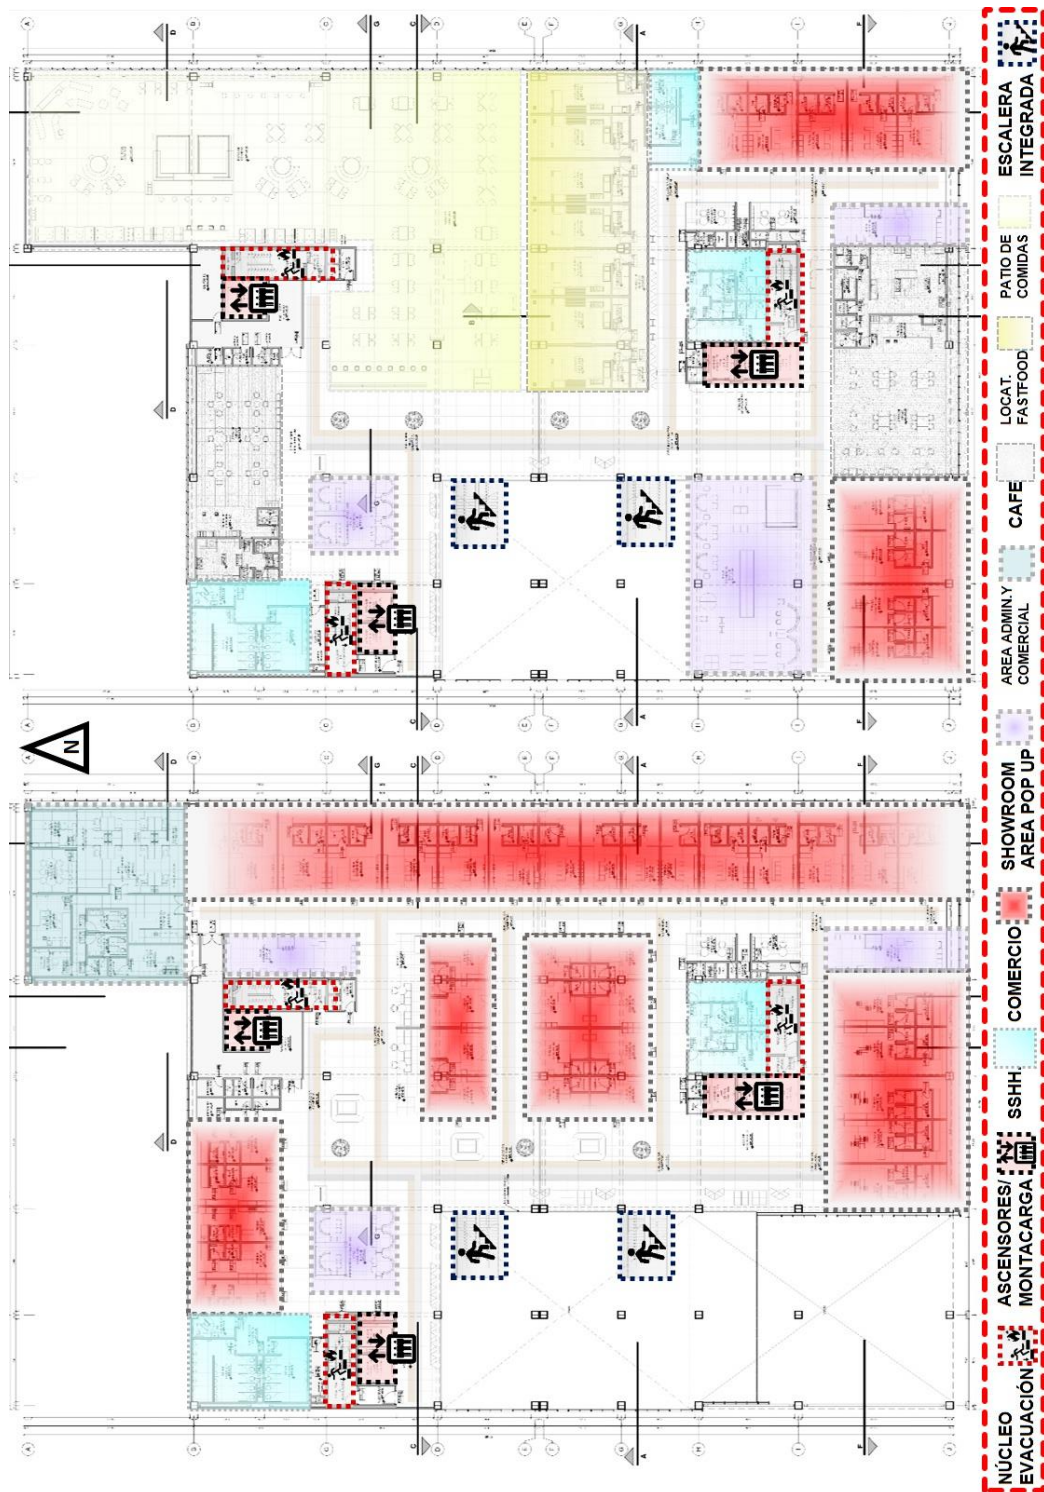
Vistas de las plantas generales del segundo piso (inferior) y del tercer piso (superior).
